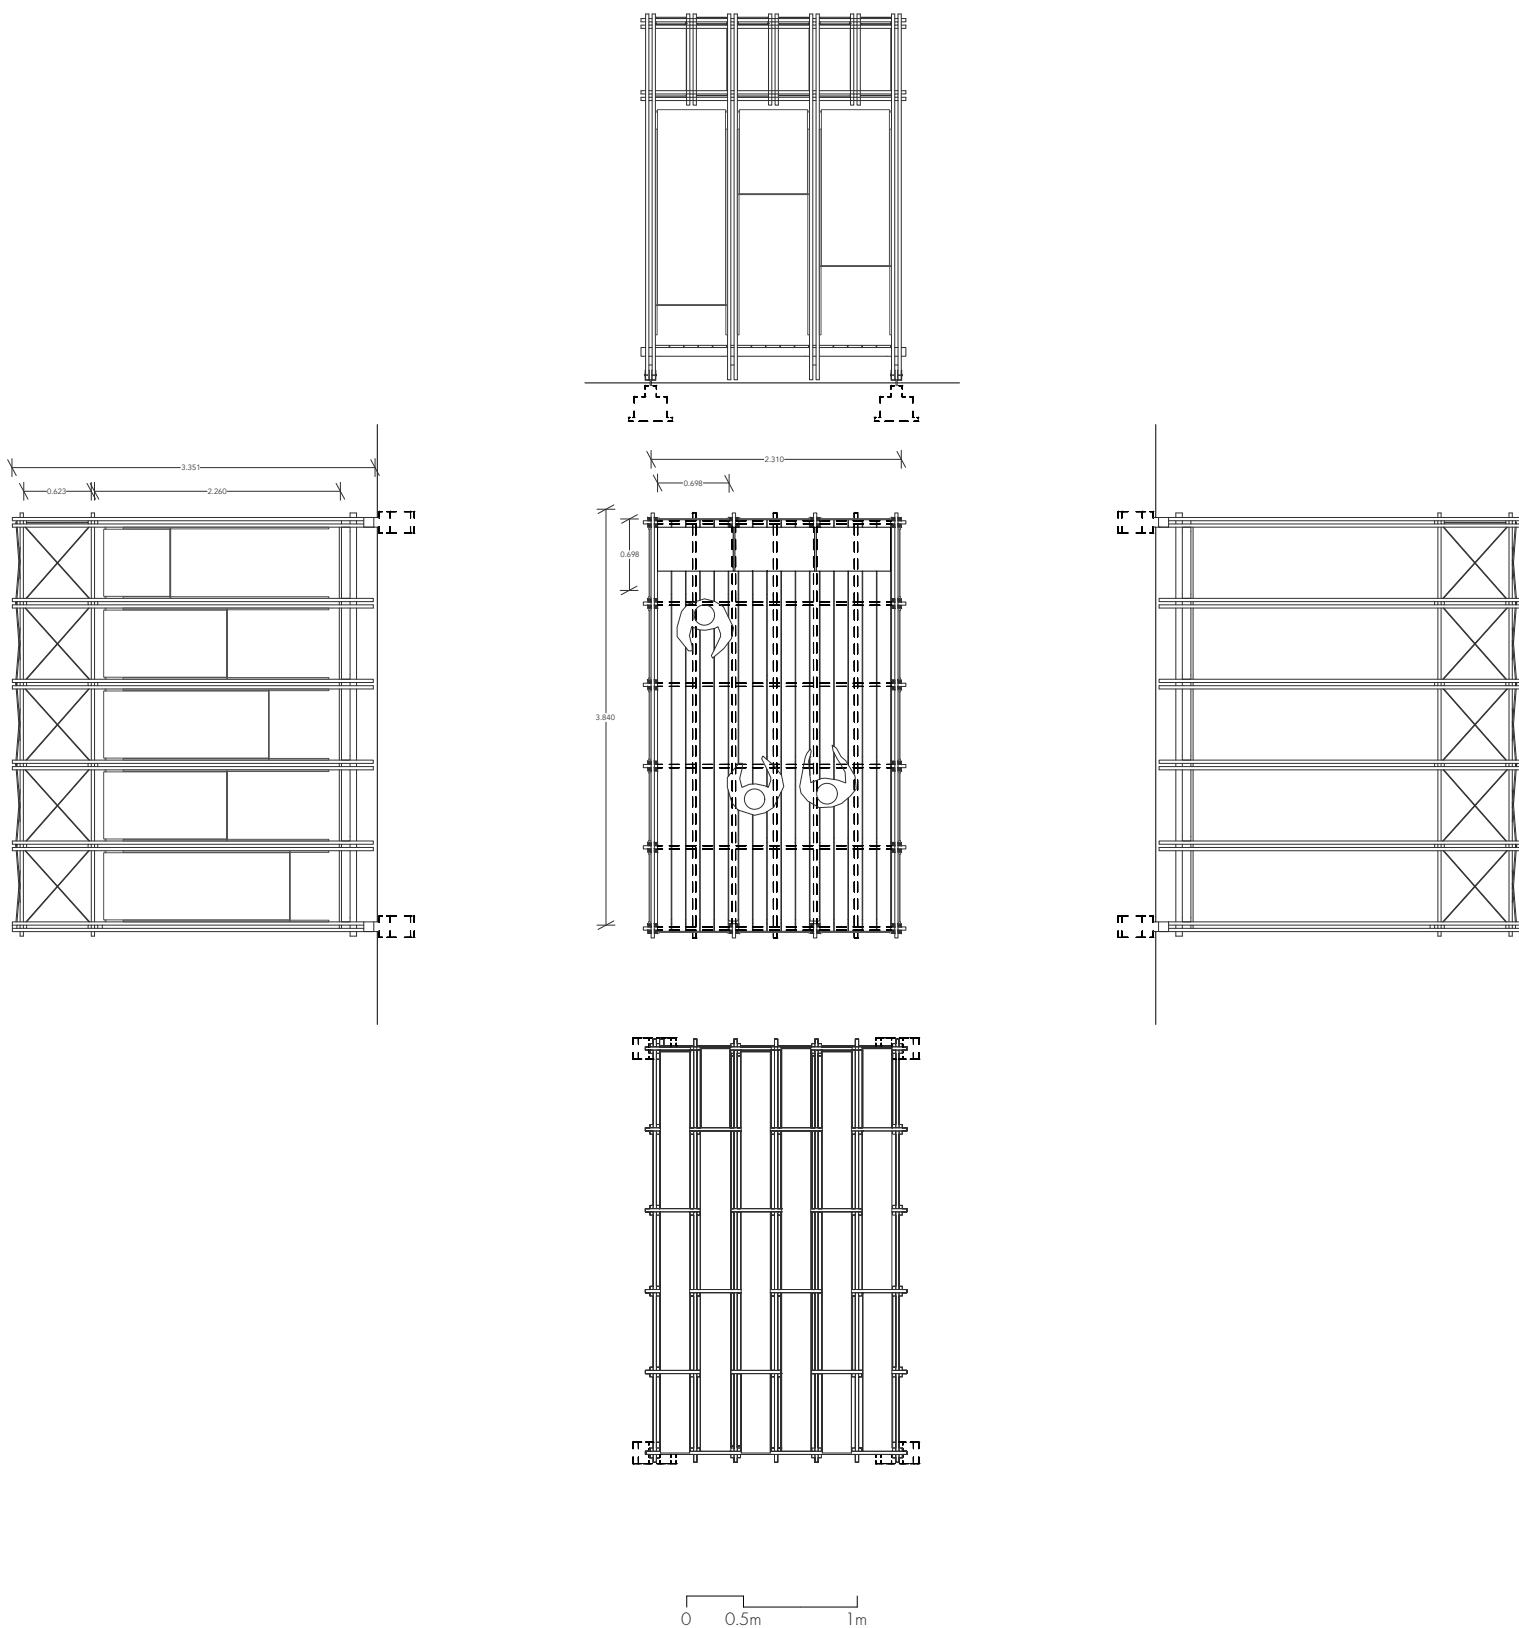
Plantas e alçados, elemento efêmero na marginal ou quebramar
